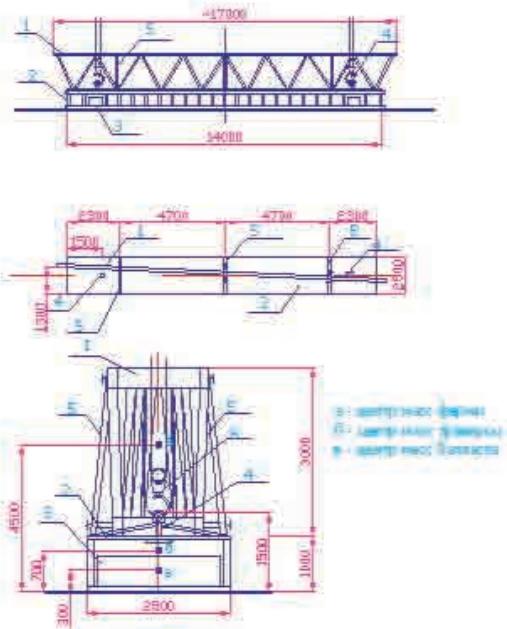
Схема "траверсы-касеты" для подъема подстропильной фермы
